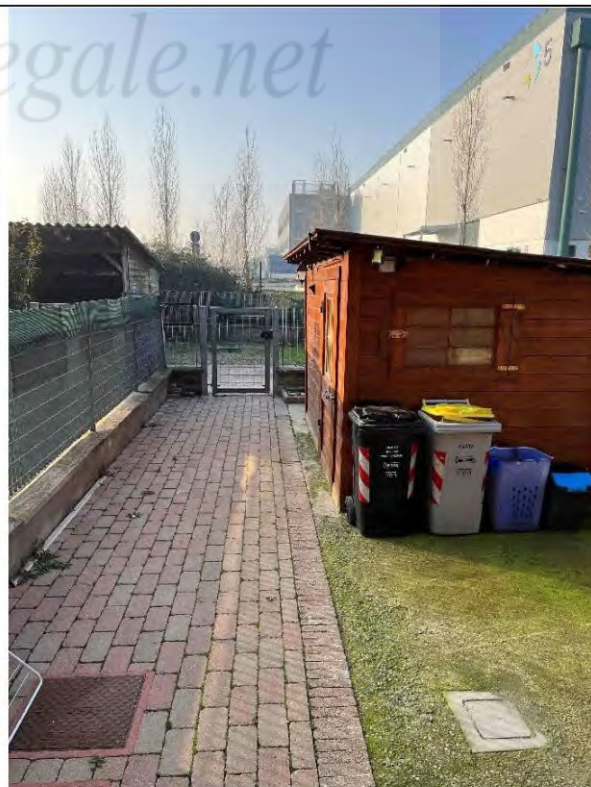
vista dell'area di proprietà dall'ingresso dell'appartamento
